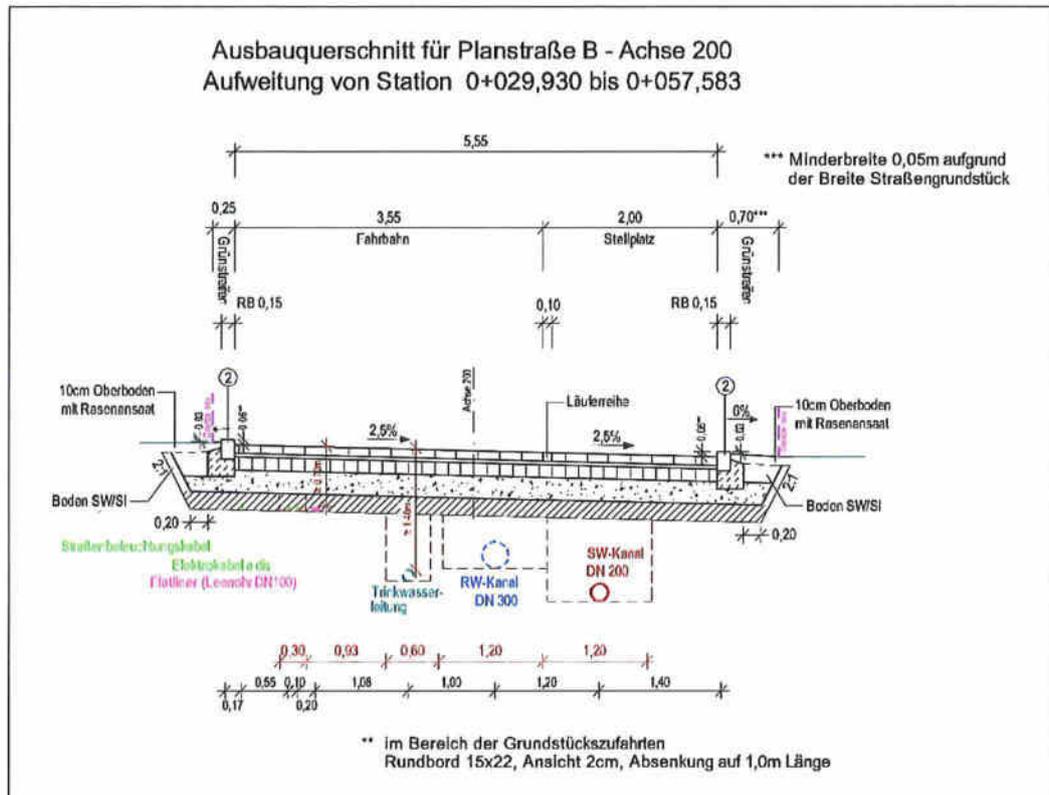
Empfehlung für den Straßenquerschnitt – Fahrbahn mit straßenbegleitendem Parken im nördlichen Bereich (Quelle: Ausführungsplanung, IBL Schwerin –Ingenieurbüro Leirich, Stand: 11/2022)
